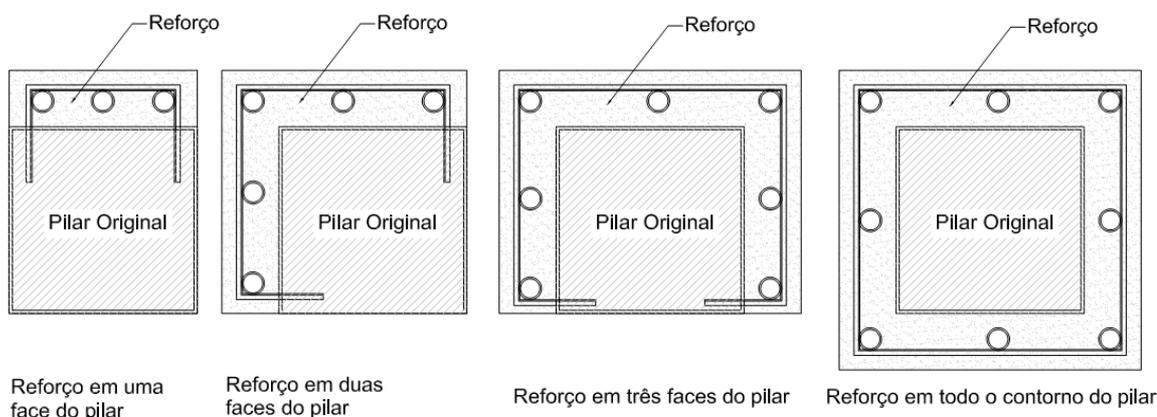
Configurações de reforço com adição de armadura e concreto em pilares (Takeuti, 1999)
